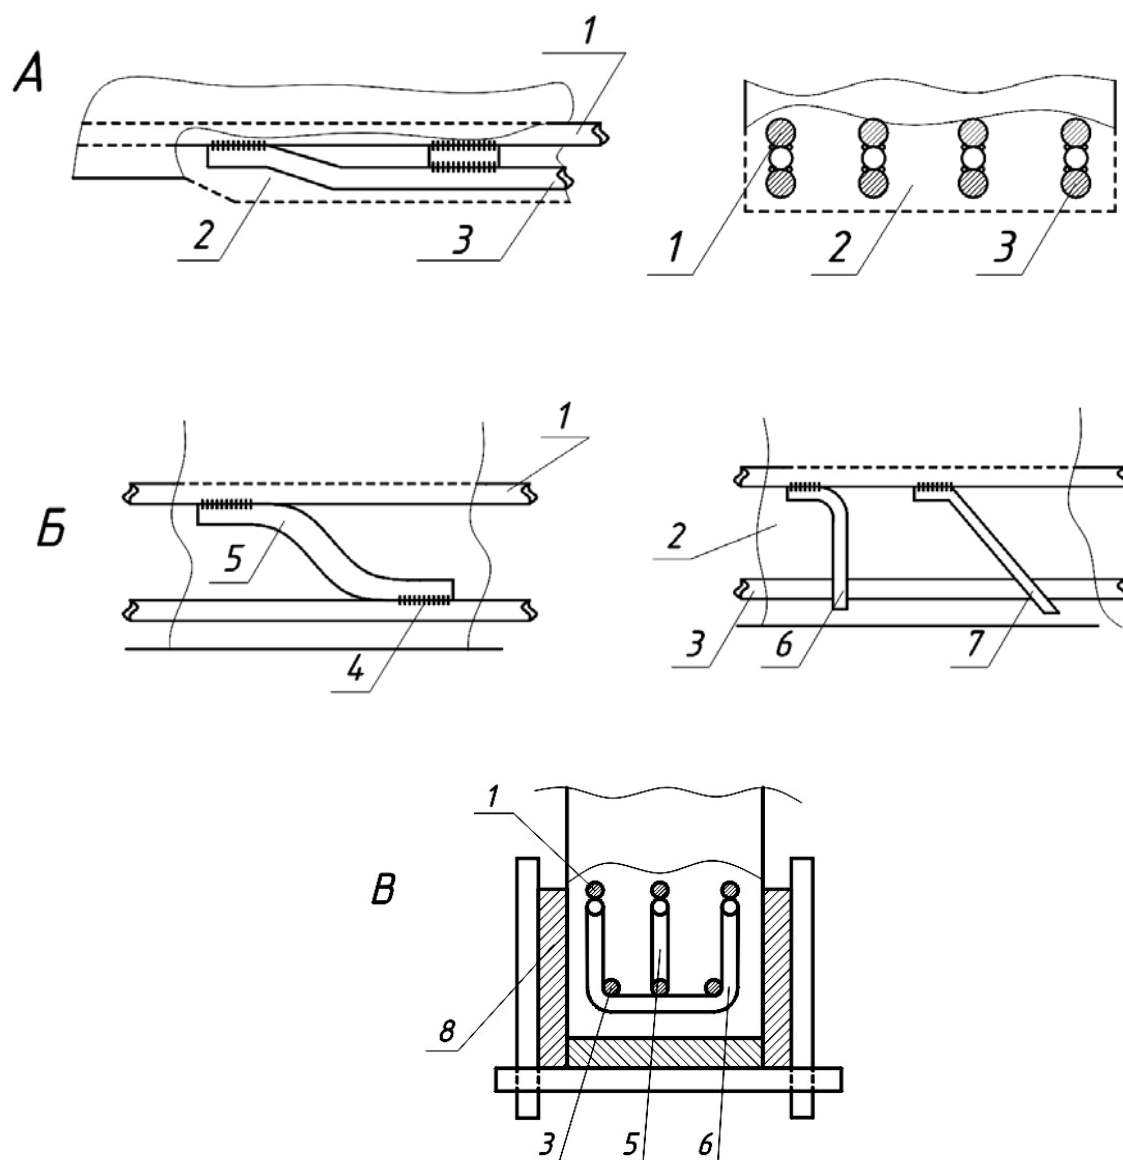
Усиление железобетонных балок добавочной арматурой:
